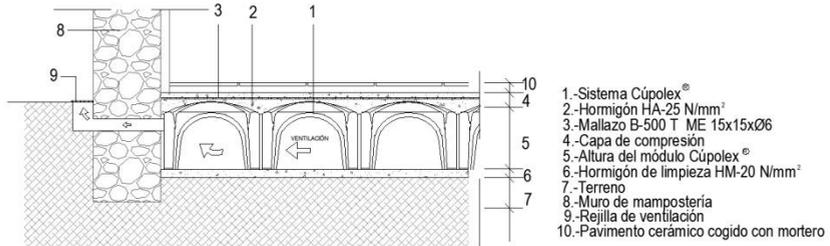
Detalle forjado sanitario ventilado. 2015. Fuente: J.C.A.
